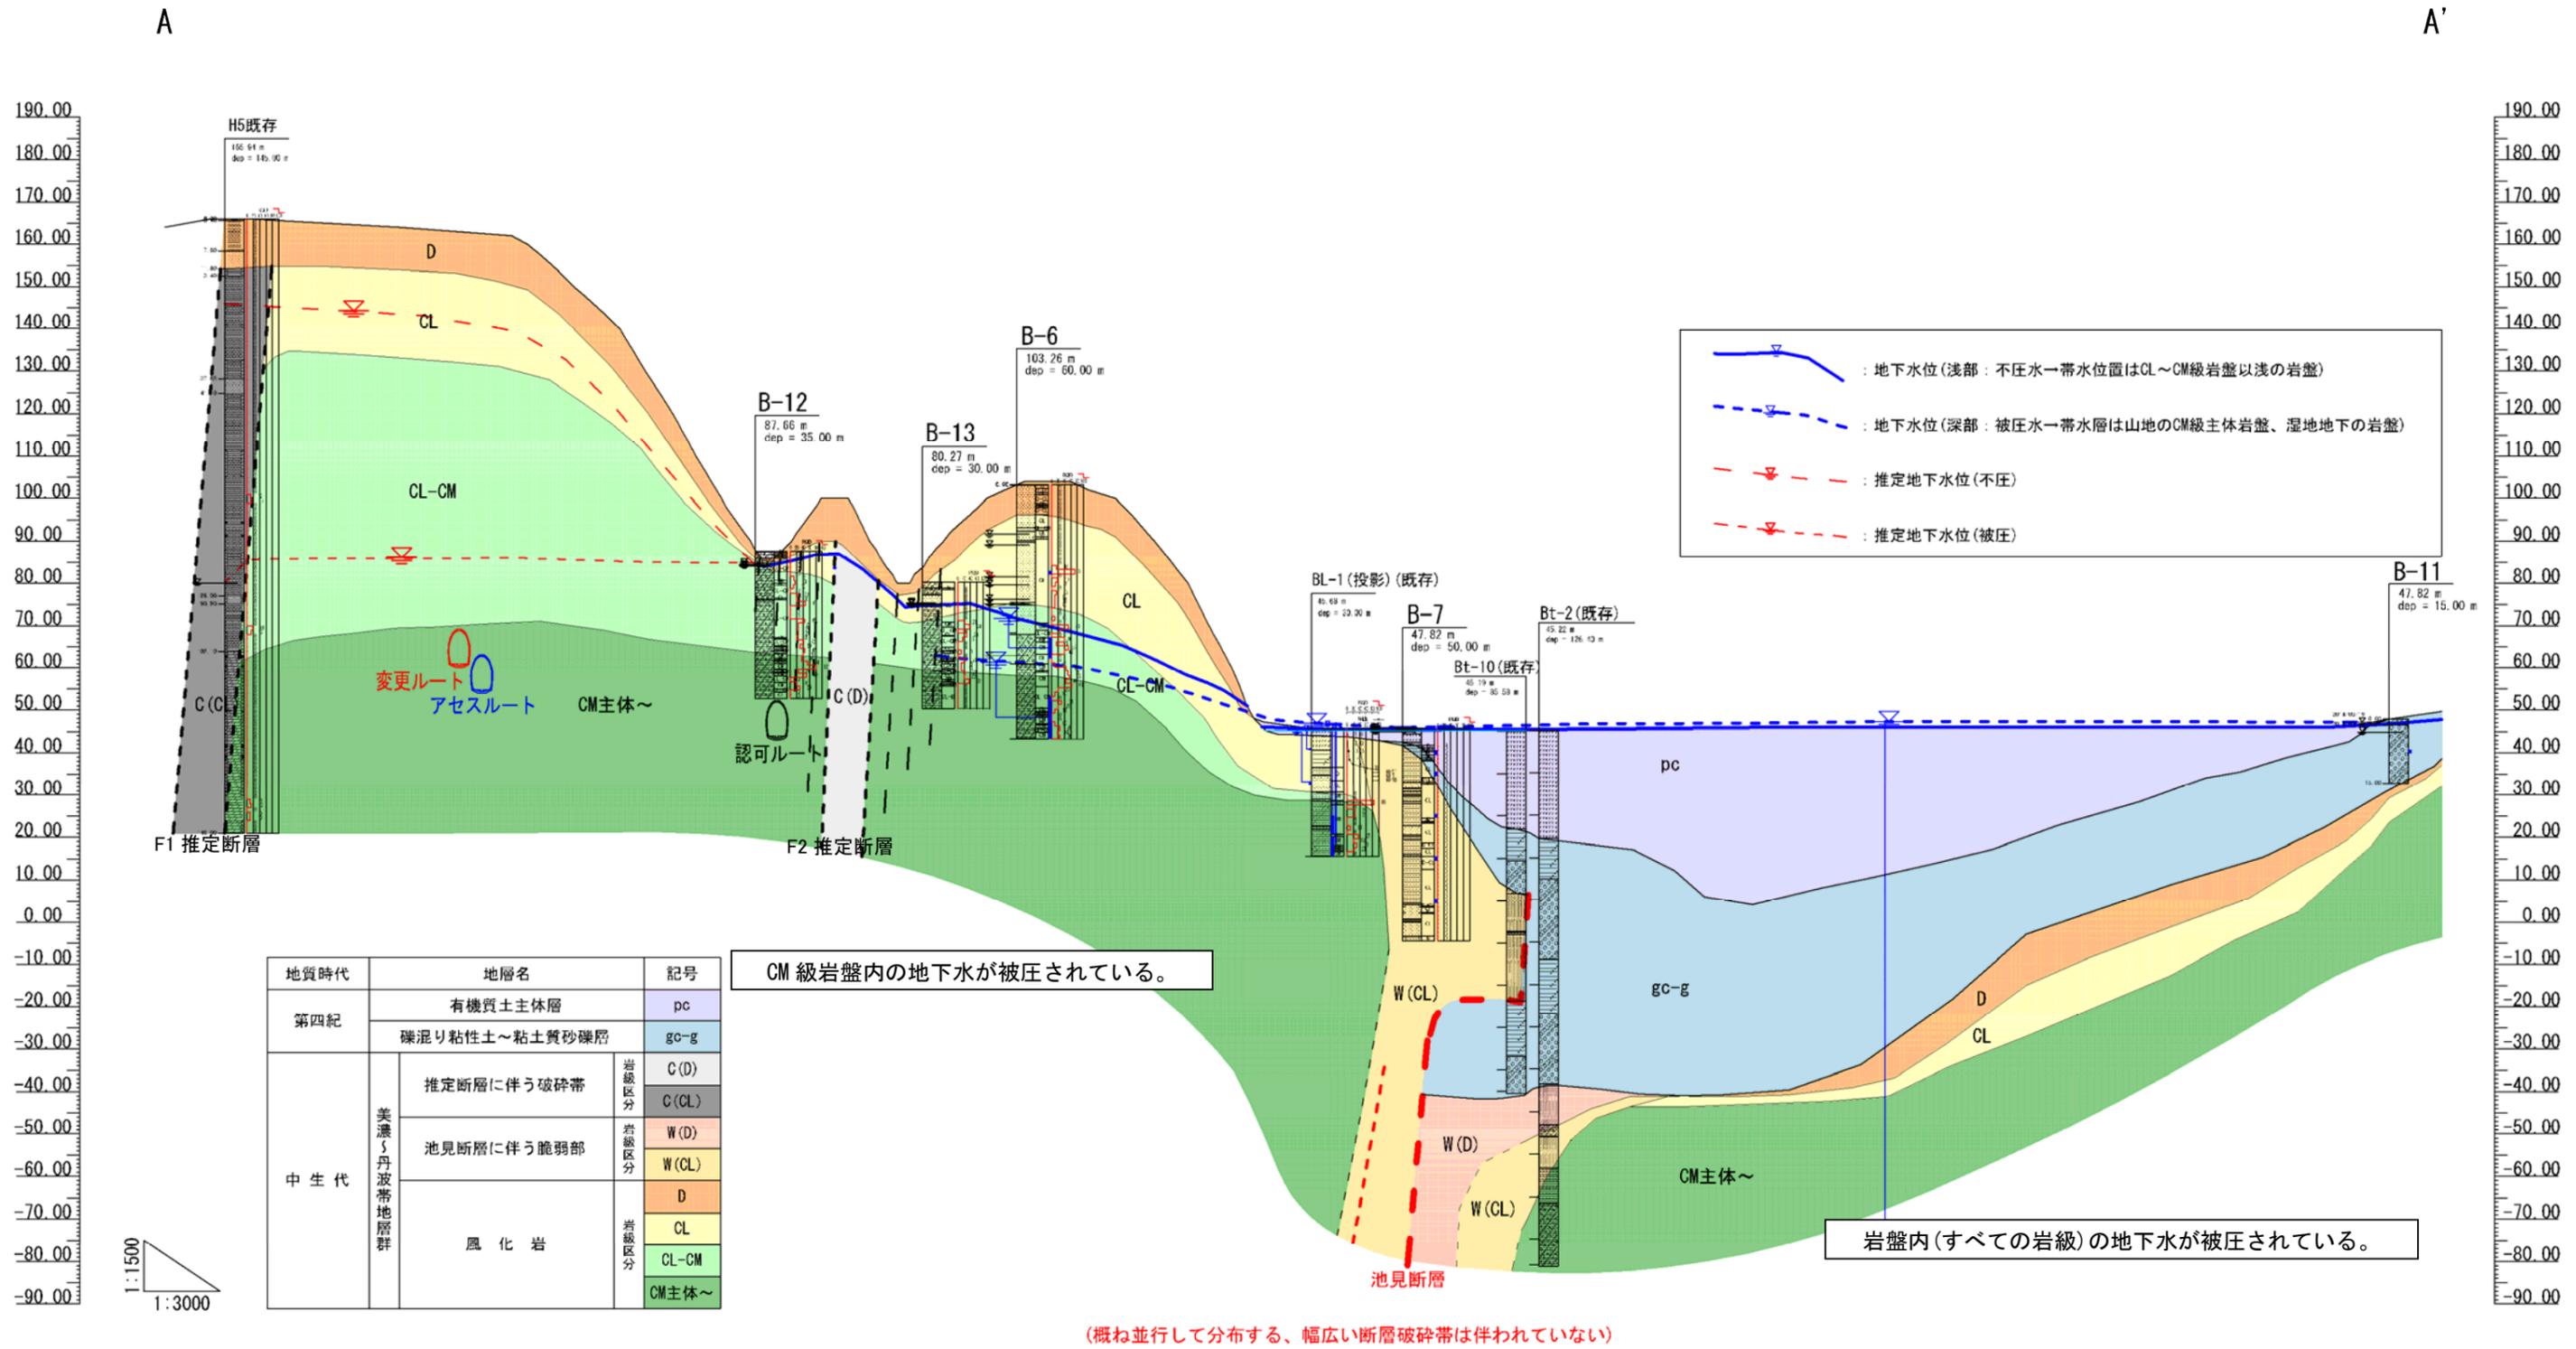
水理地質構造解釈断面図(断面図(A-A' 断面))
